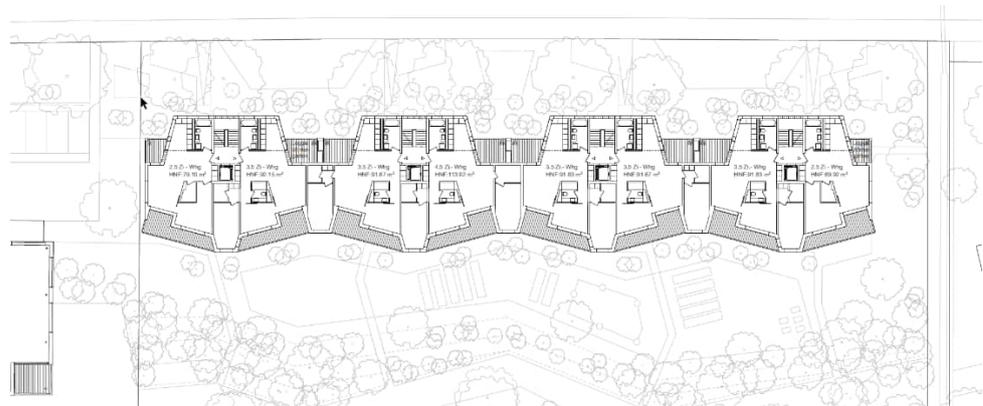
Grundriss 1. OG (Bob Gysin Architekten 2024)
